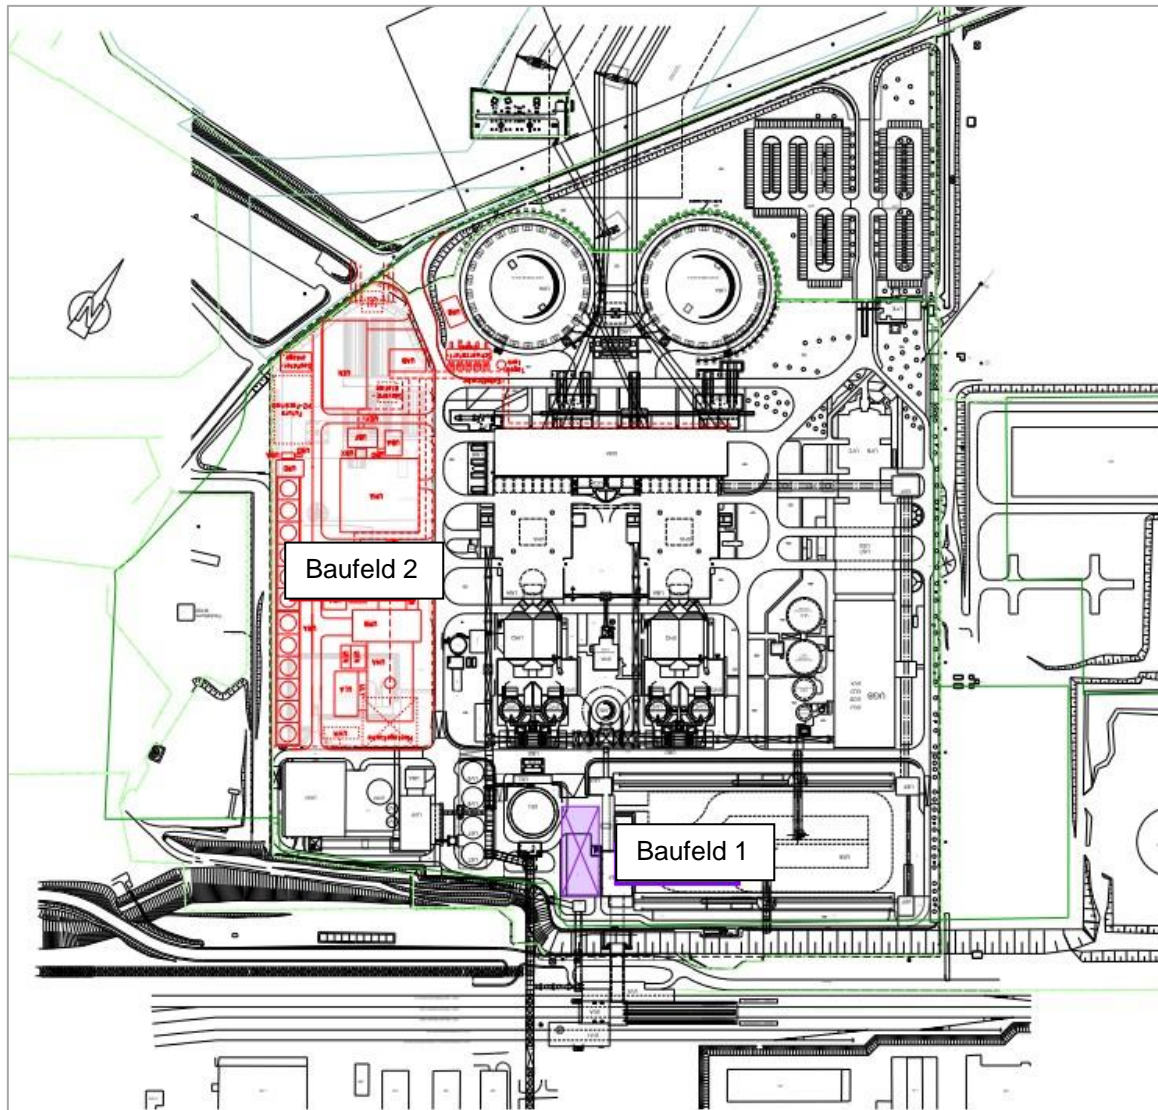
Lageplan des Kraftwerks Schkopau mit geplanter IGT im Baufeld 1 und GuD im Baufeld 2
